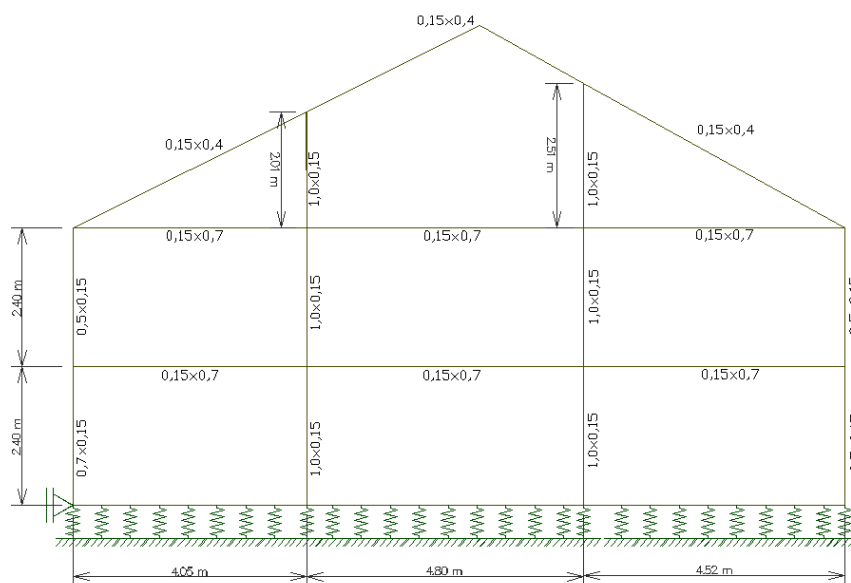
Dimensões e geometria das vigas e pilares do pórtico 1-1'
